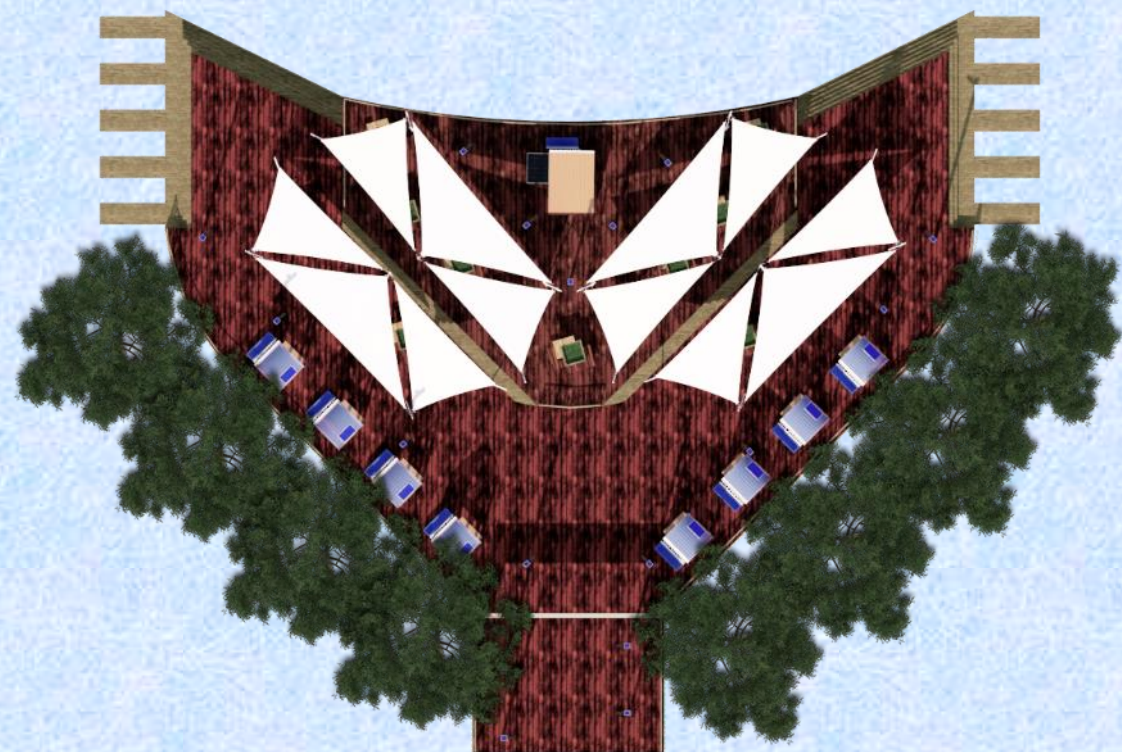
Implantación y planta plataforma 1. Fuente: Elaboración propia
